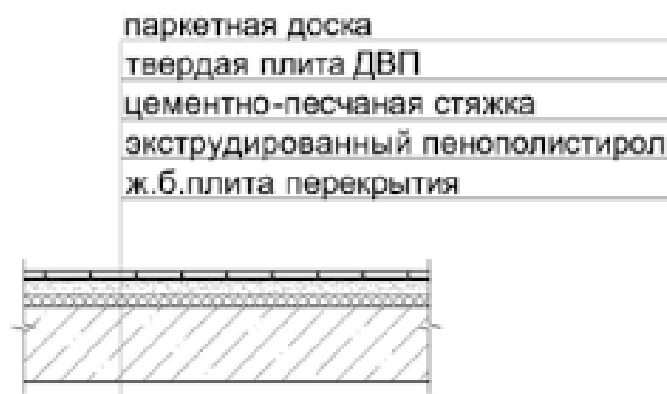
Конструктивне рішення залізобетонного монолітного перекирття
